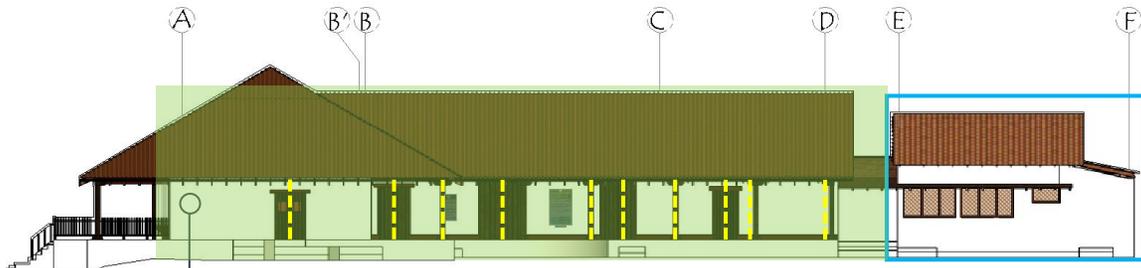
Elementos arquitectónicos, Fachada Este.
